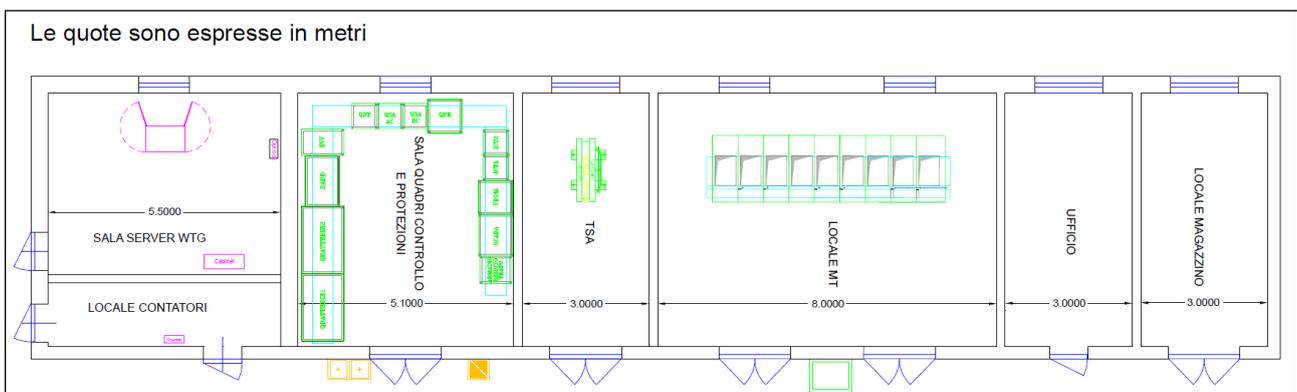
Pianta edificio di controllo SEU 150/30 kV
